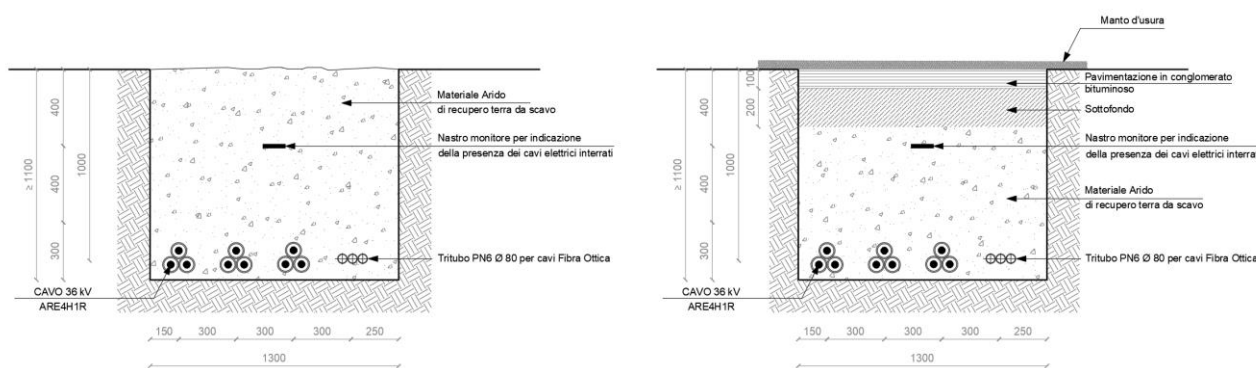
Tipico modalità di posa cavidotto a 36 kV di collegamento della centrale eolica alla RTN
